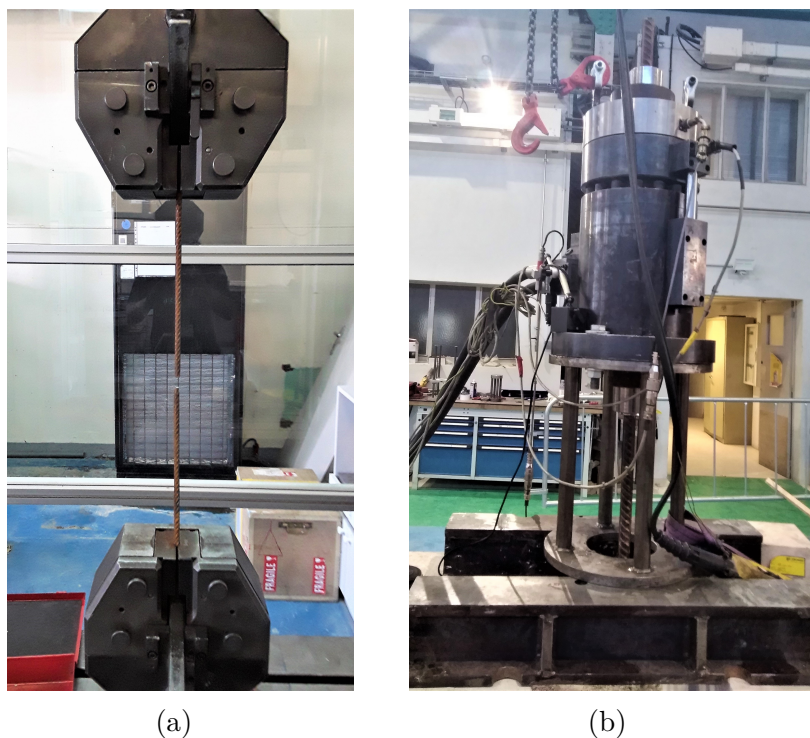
Dispositifs de caractérisation des armatures (a) transversales et (b) longitudinales
